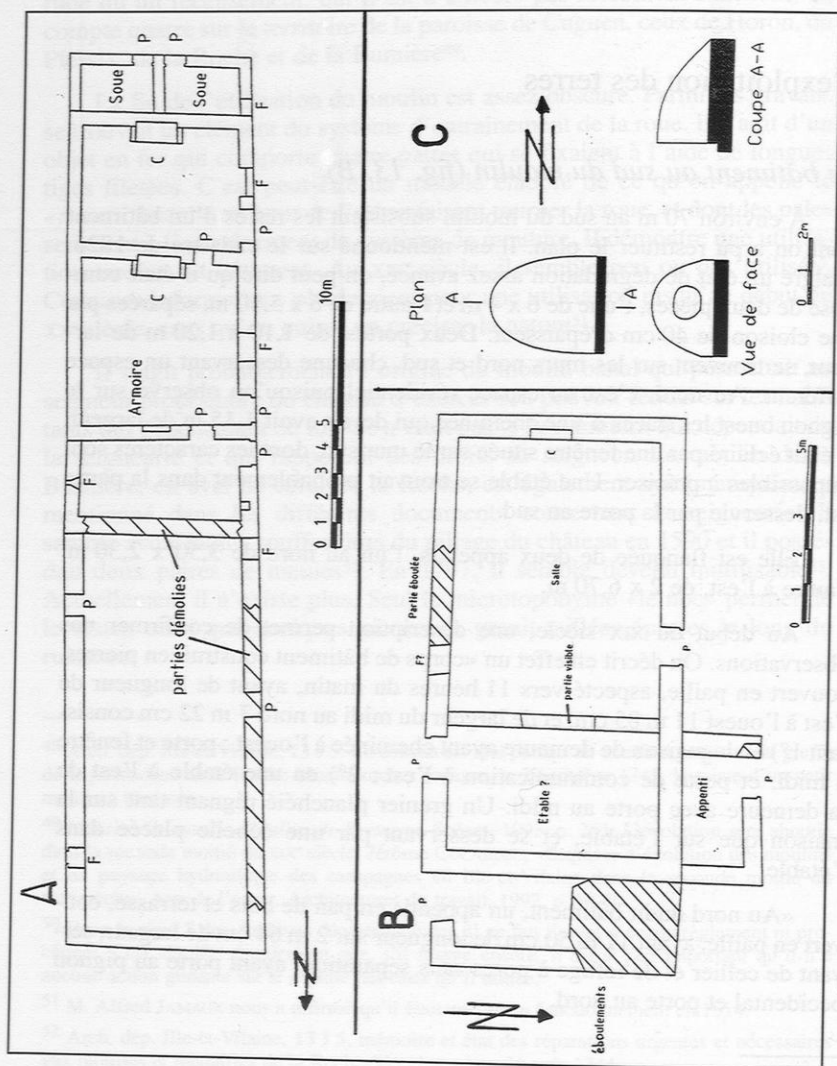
A : plan du rez-de-chaussée de la métairie. B : plan du bâtiment au sud du moulin ;
